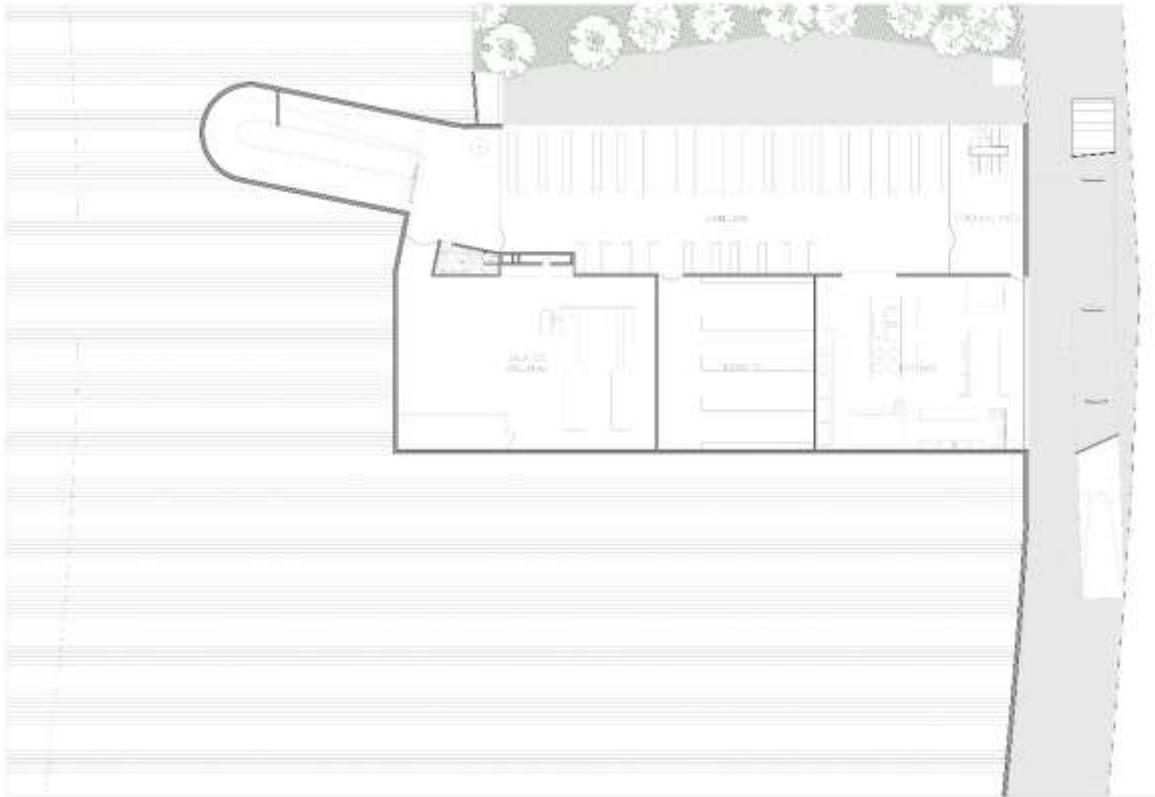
/ Planta SS N+22,10 1958, REVISITADA según lamina 16.855 DDI-IH
